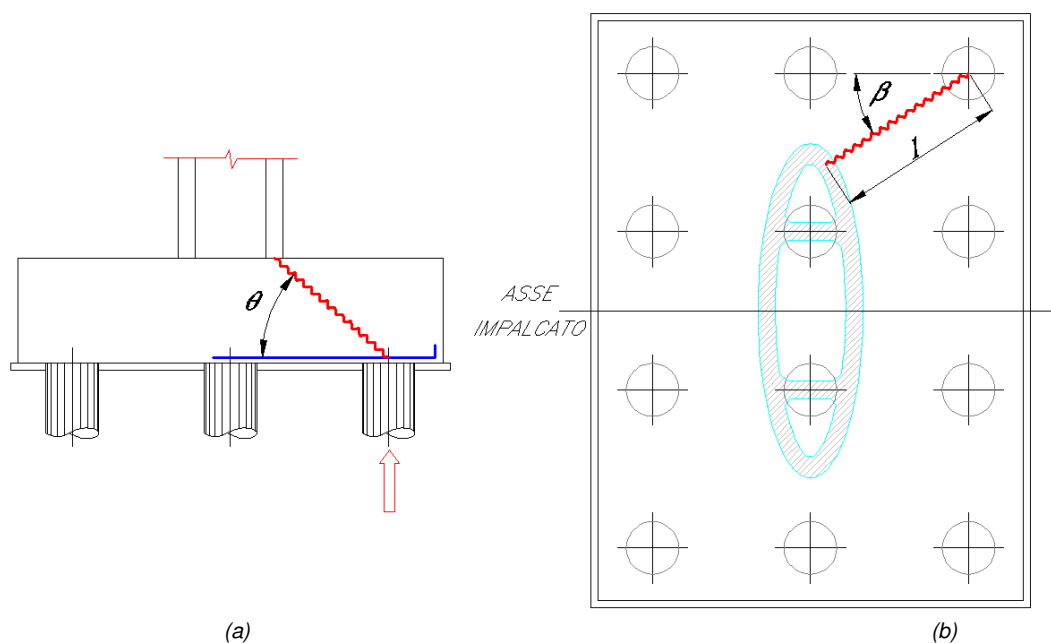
Schema tipologico tirante-puntone: (a) sezione verticale e (b) vista in pianta.
